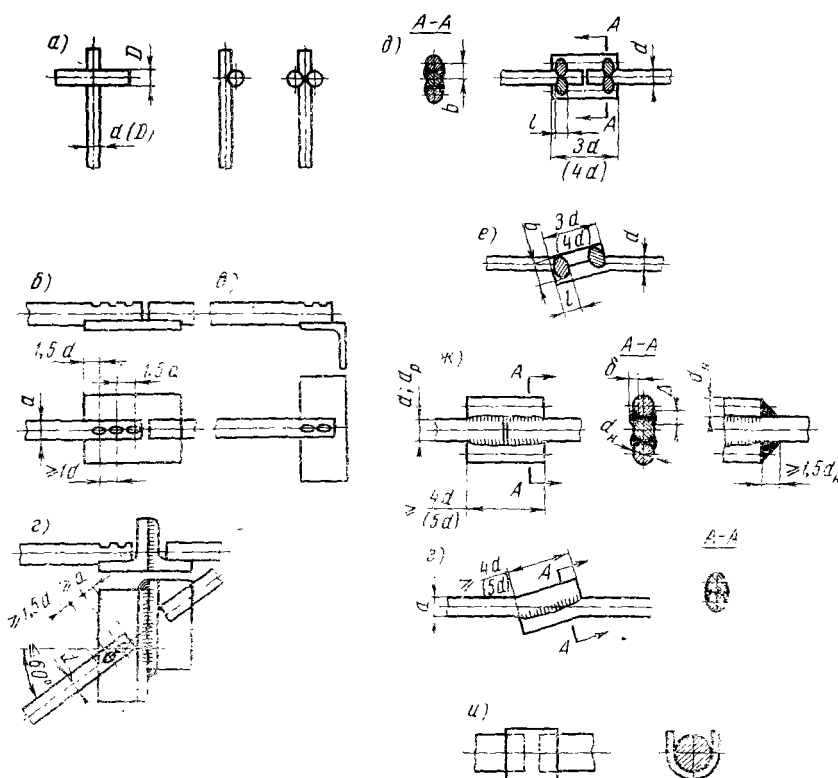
Примеры сварных соединений арматуры железобетона (в скобках указаны размеры арматуры периодического профиля)
